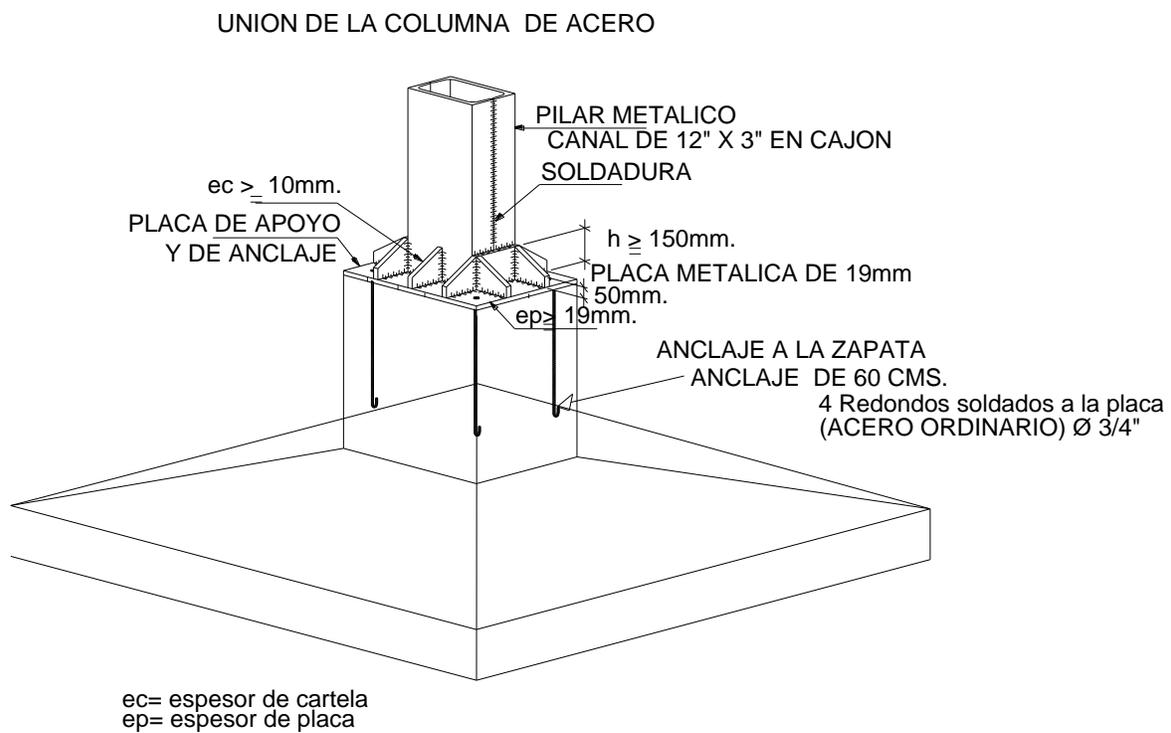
Detalle de placa base y unión de pilar metálico.
